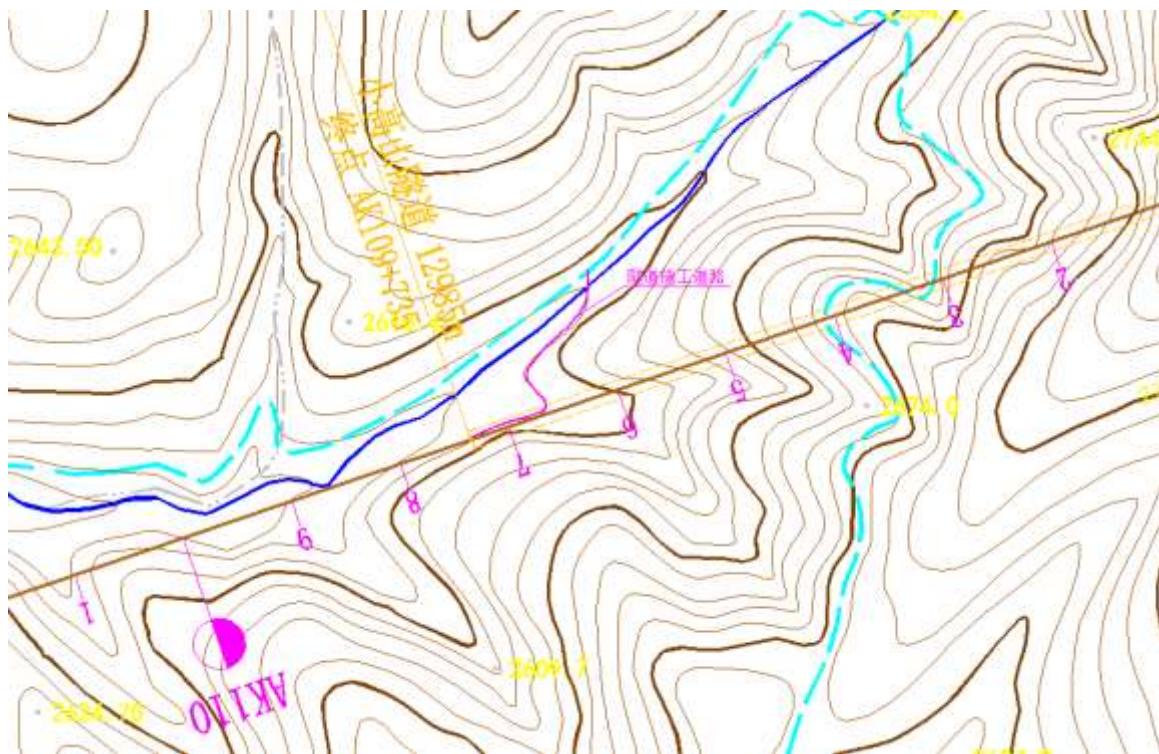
小高山隧道出口典型施工道路示意图
